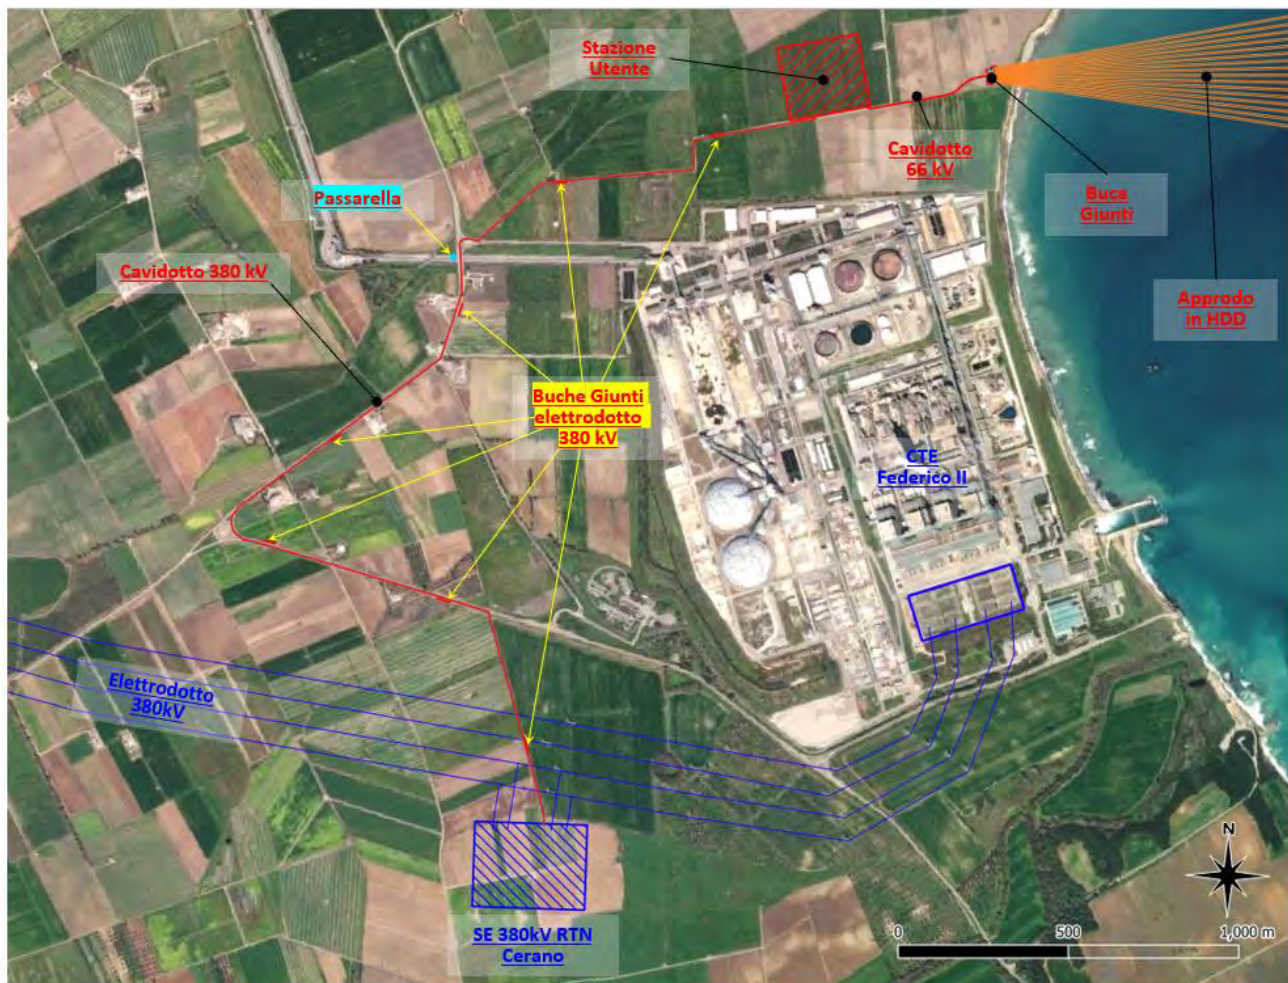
Planimetria buche giunti e passarella cavidotto 380 kV.
